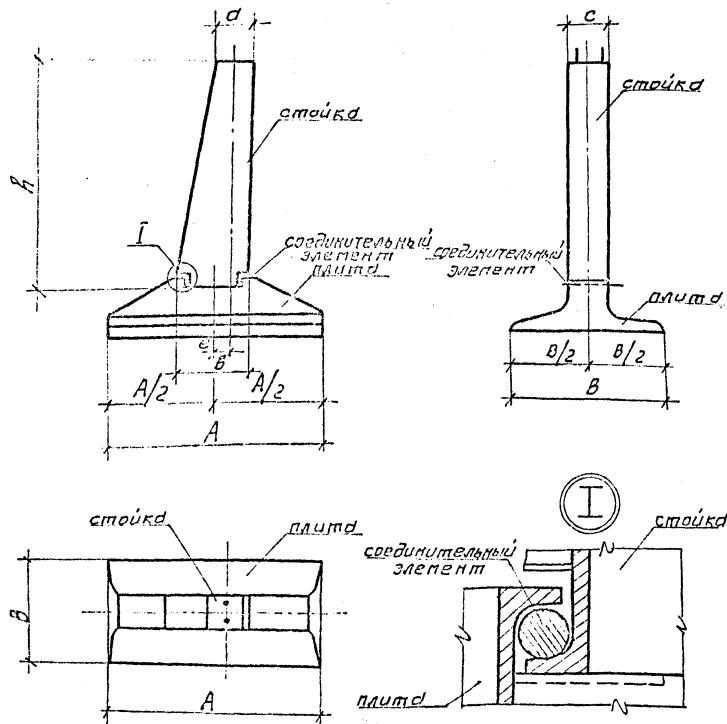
Конструкции унифицированных железобетонных элементов фундаментов
